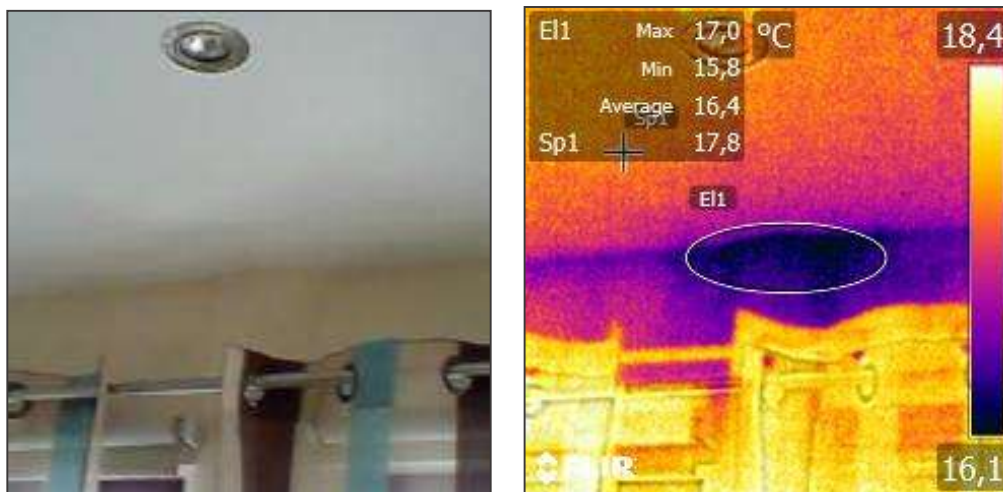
Ponte térmica na zona do pilar que atravessa a parede
